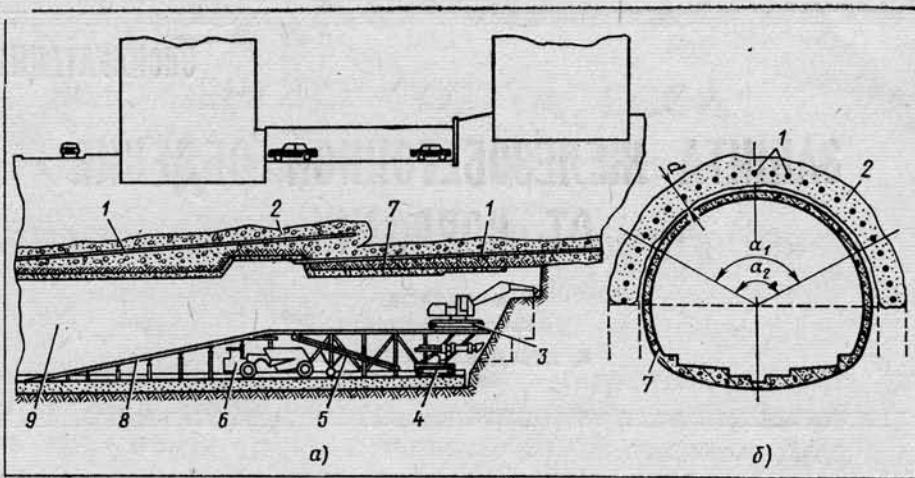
Технологическая схема проходки тоннеля (а) и схема ледогрунтового свода над выработкой (б):
